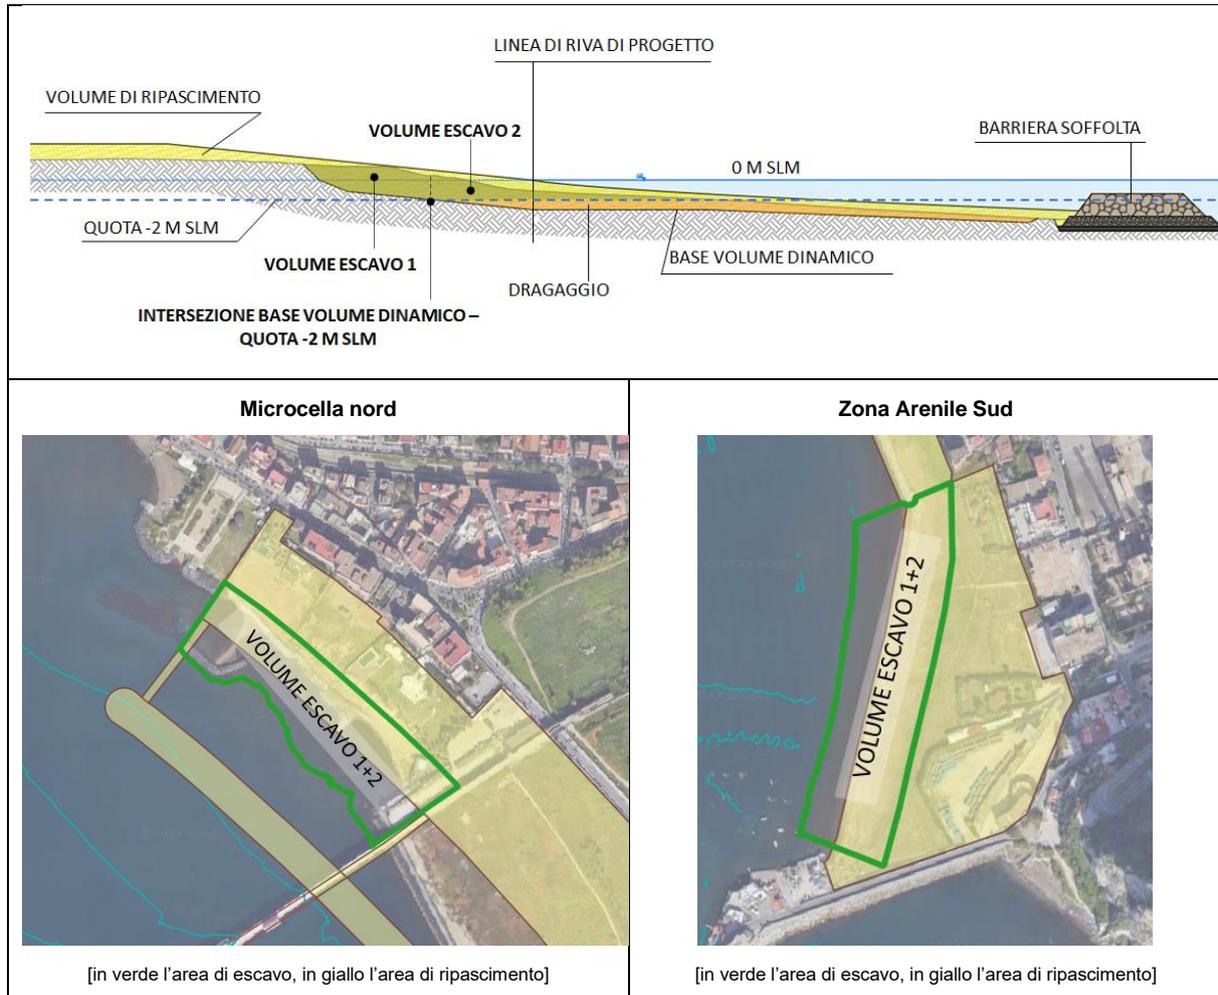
Rappresentazione del volume di escavo in sezione e in pianta
